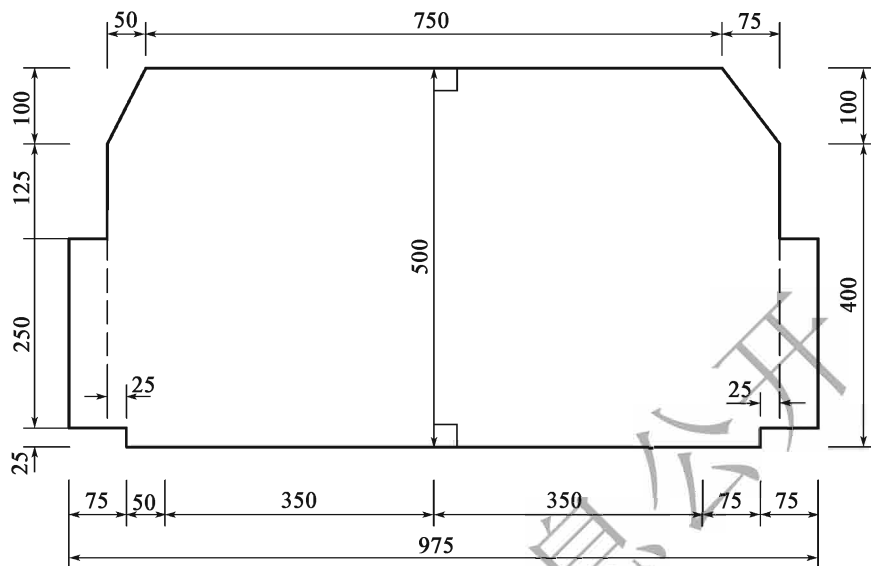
Dégagement de construction du tunnel routier de première classe à deux voies(60km/h) (unité:cm)
